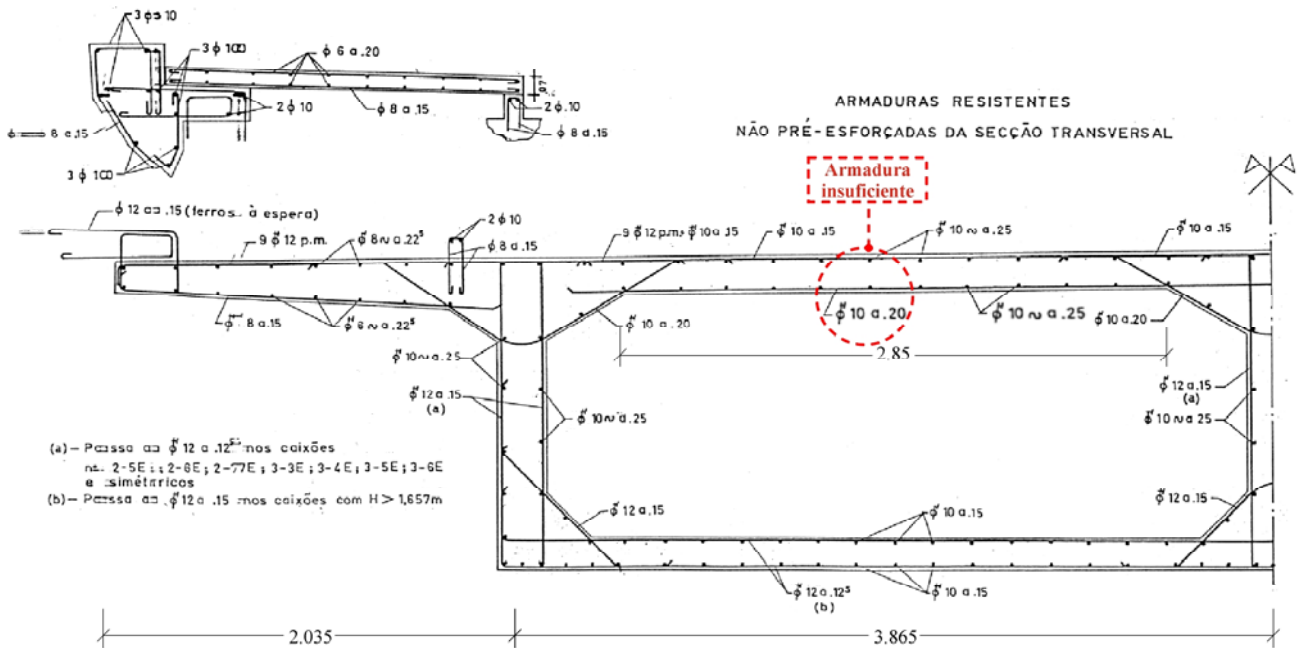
Secção transversal tipo da viga em caixão da “Ponte N. S. G.” (Figueiras et al., 1999).
